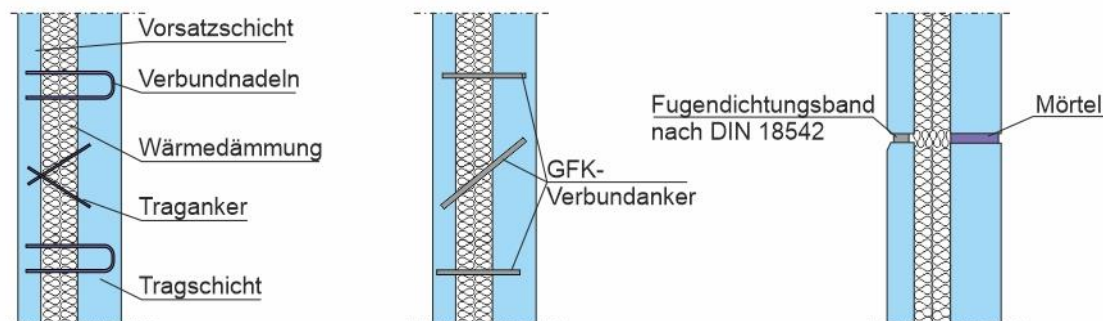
Prinzipielle Fassadenausbildungen und typisches Fugendetail für Sandwichelemente
